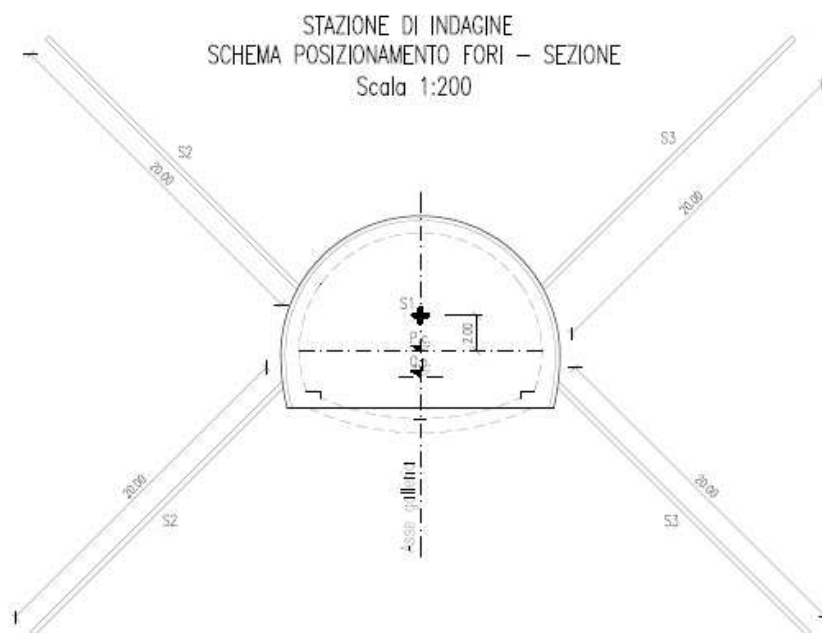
Indagini sismiche in avanzamento. Schema in sezione trasversale
